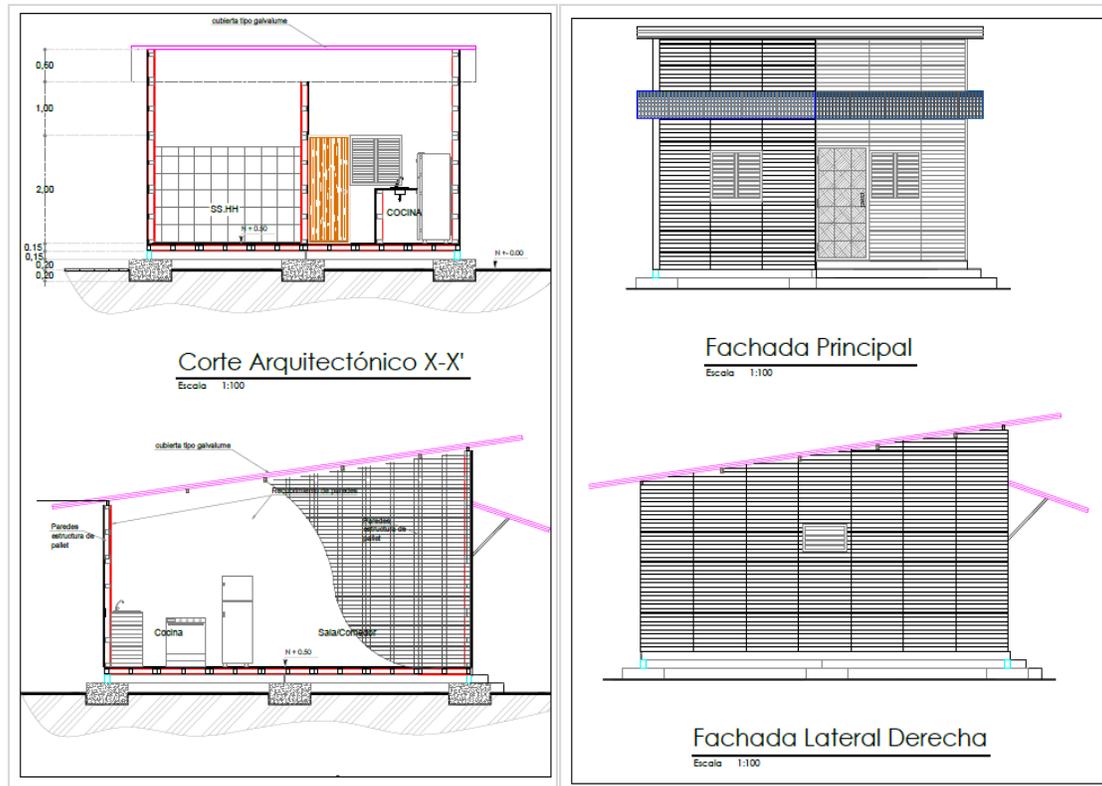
Corte Arquitectónico y fachada con paneles tipo sándwich
